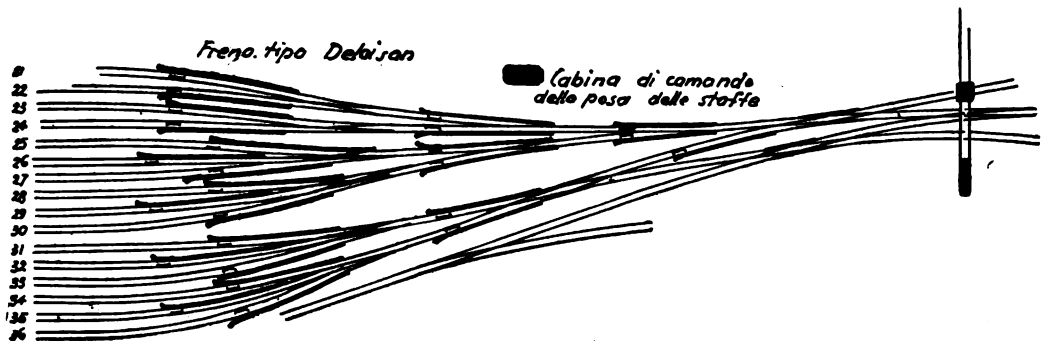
Disposizione planimetrica di una stazione munita di freni a scarpa comandati a distanza.
